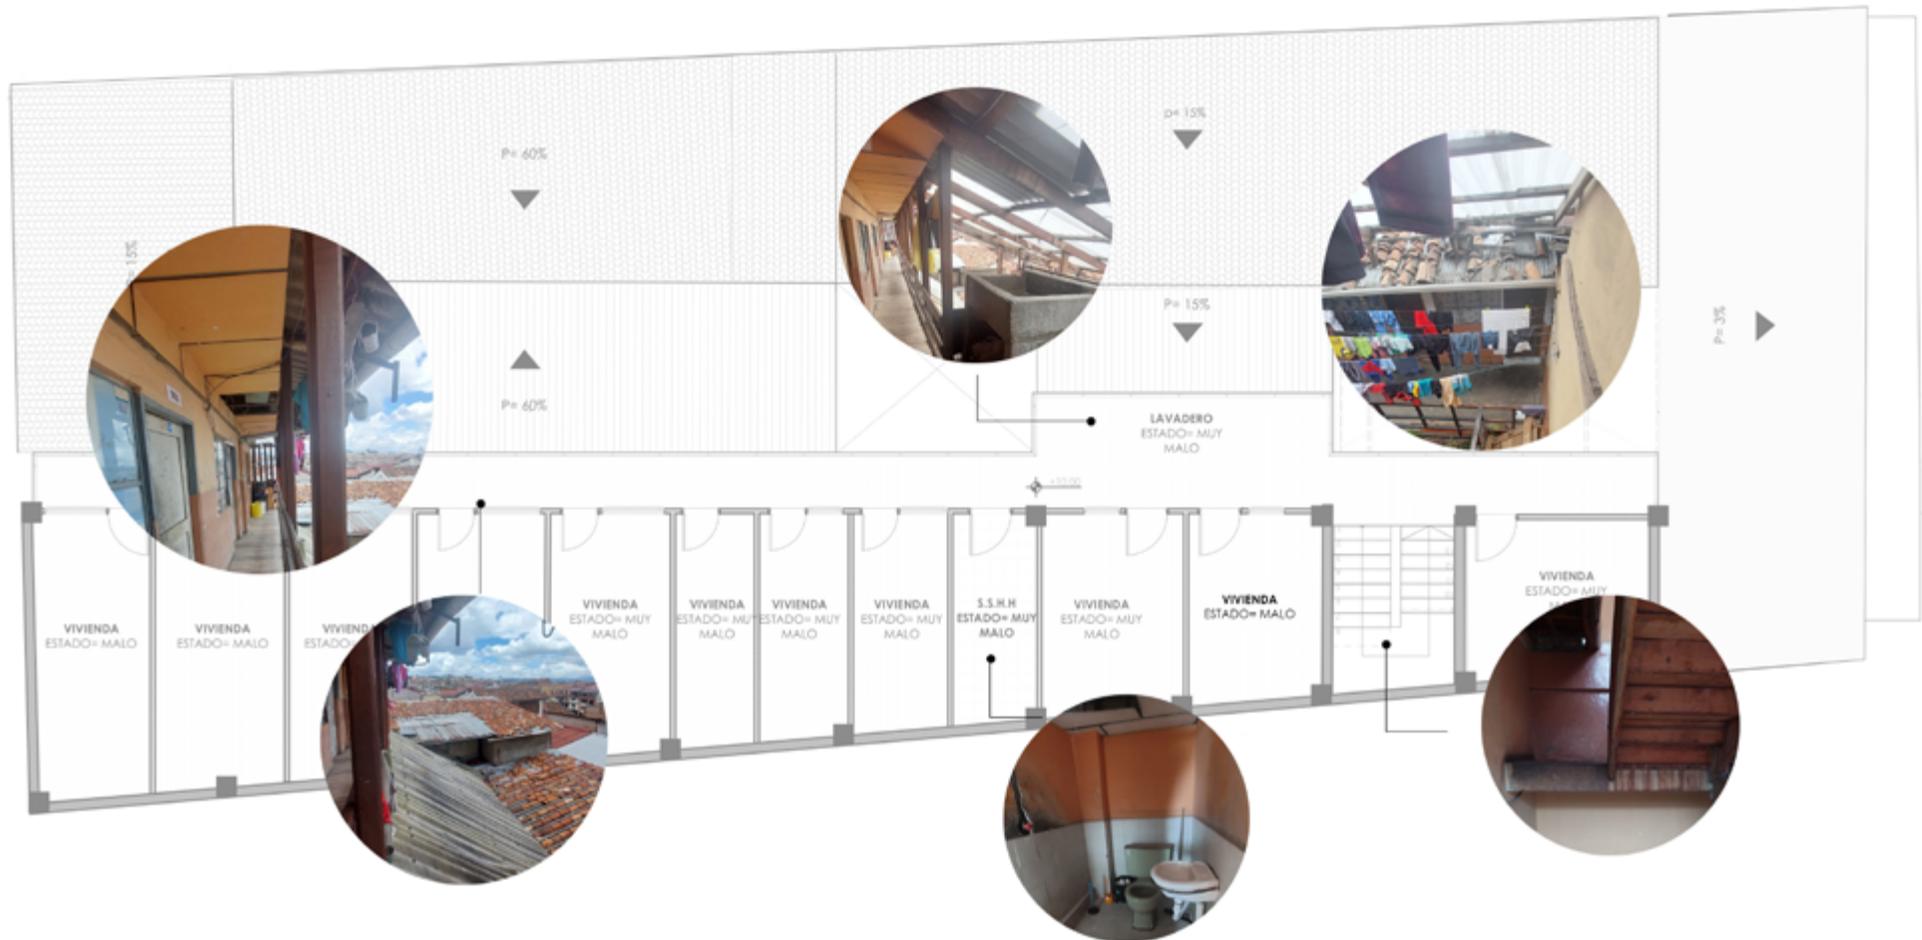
Vistas al rededor de la cuarta planta alta. Autoría propia [Fotografía e ilustración].
